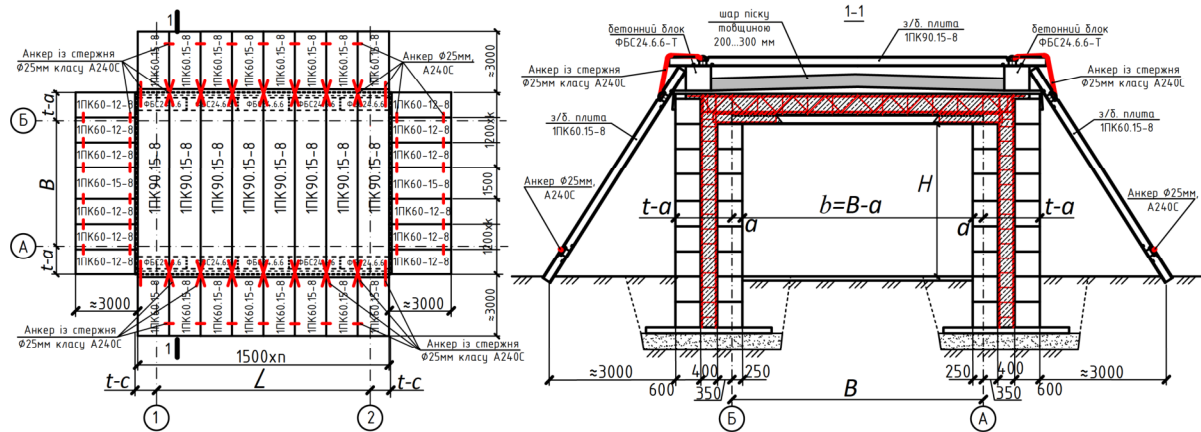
Зовнішнє захисне протиударне огородження для наземної захисної споруди критичної інфраструктури, яке улаштоване із збірних залізобетонних плит марок 1ПК90.15-8, 1ПК60.15-8, 1ПК60.12-8 і бетонних фундаментних блоків
